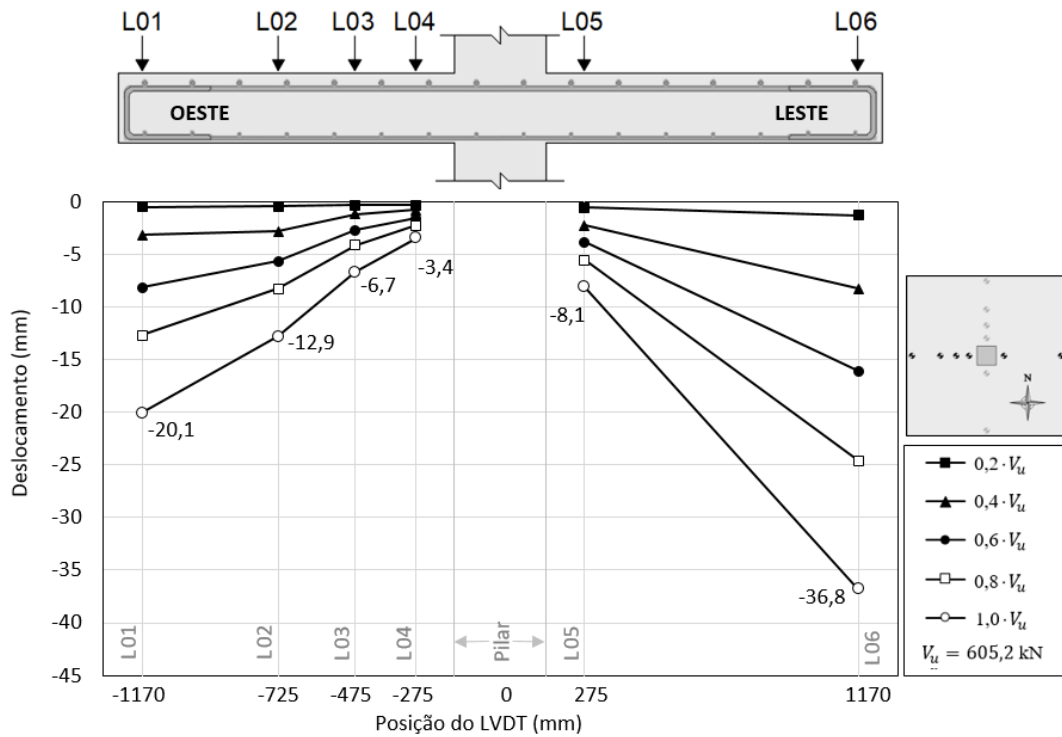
Deslocamentos verticais na direção Leste-Oeste para a laje CA-05
